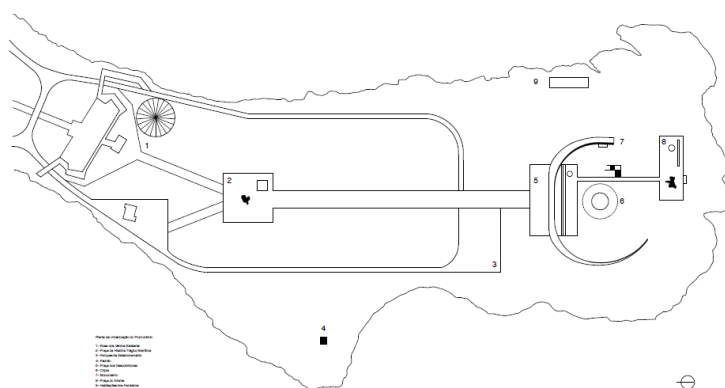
Planta de urbanização da Ponta de Sagres.
